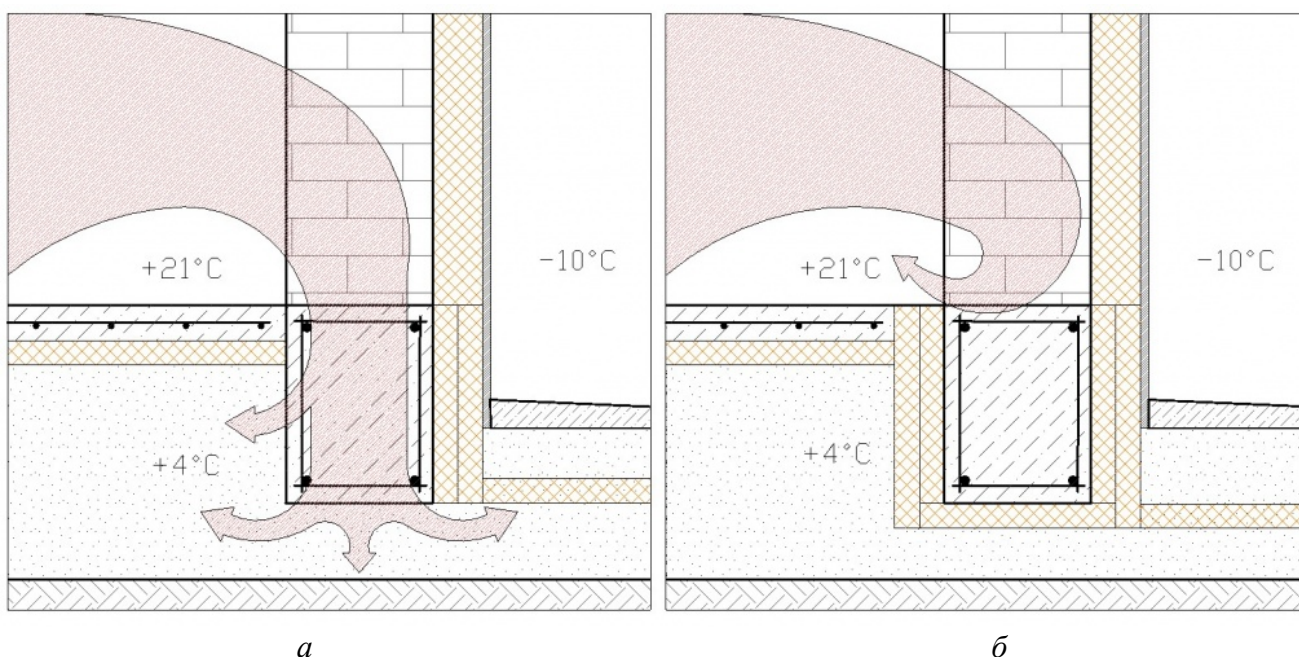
Распределение тепла по контуру здания: *а* – с использованием «классической» опалубки; *б* – с использованием несъемной опалубки из экструдированного пенополистирола
